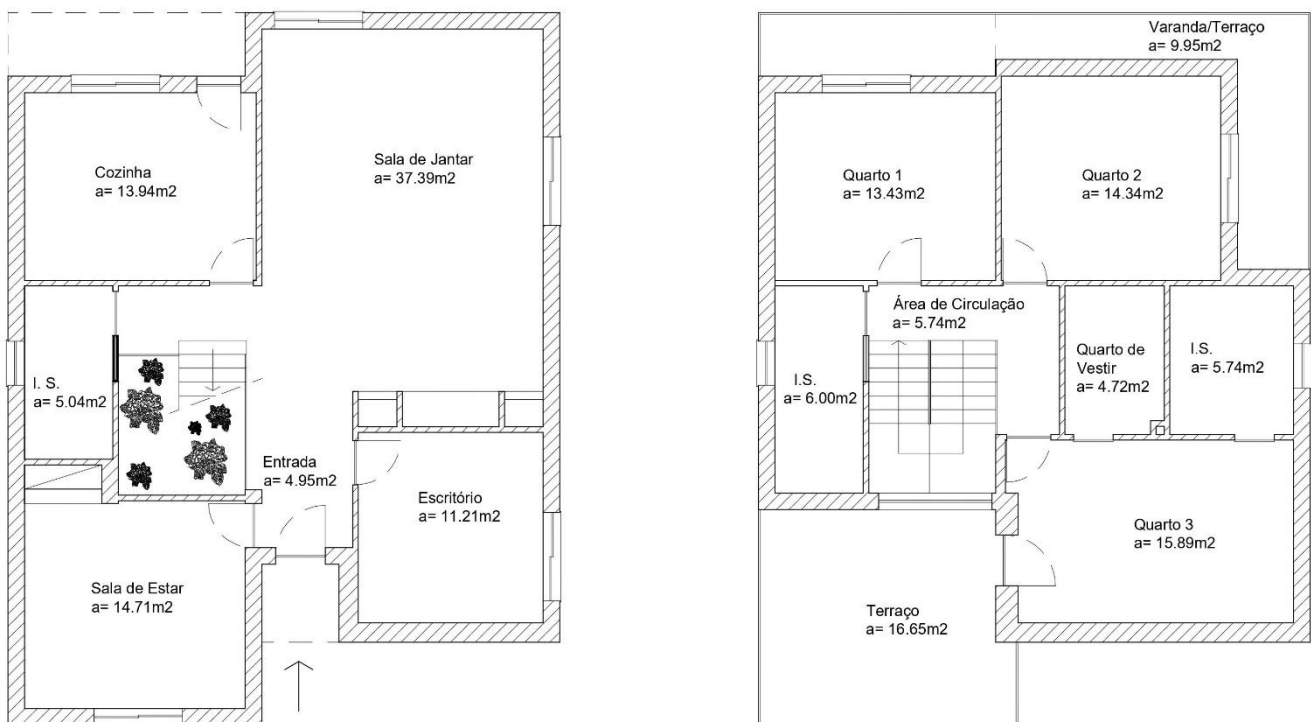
Planta de Levantamento Piso 0 e Piso 1
